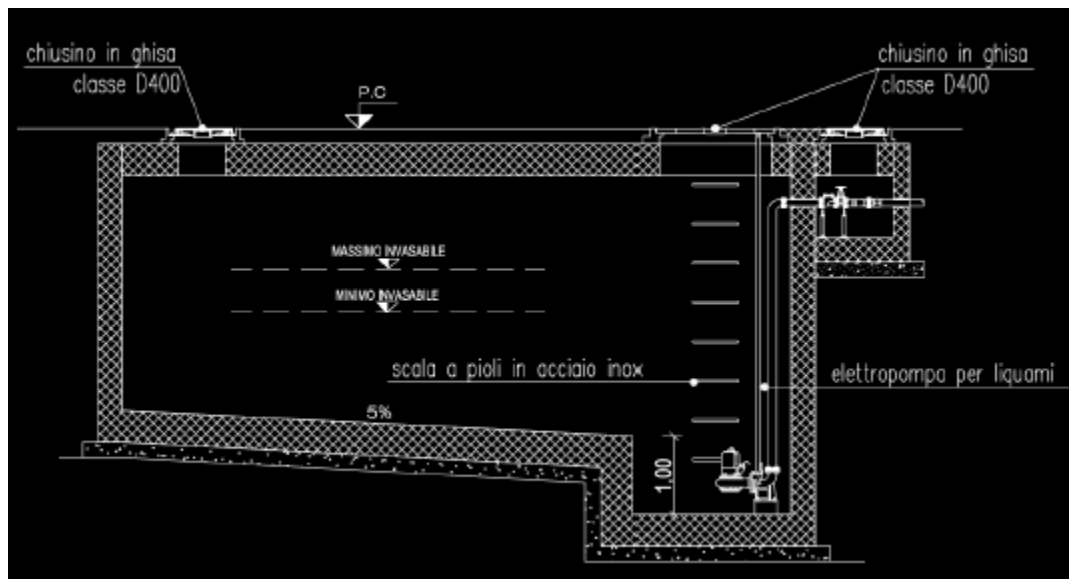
sezione longitudinale tipo vasche di prima pioggia
